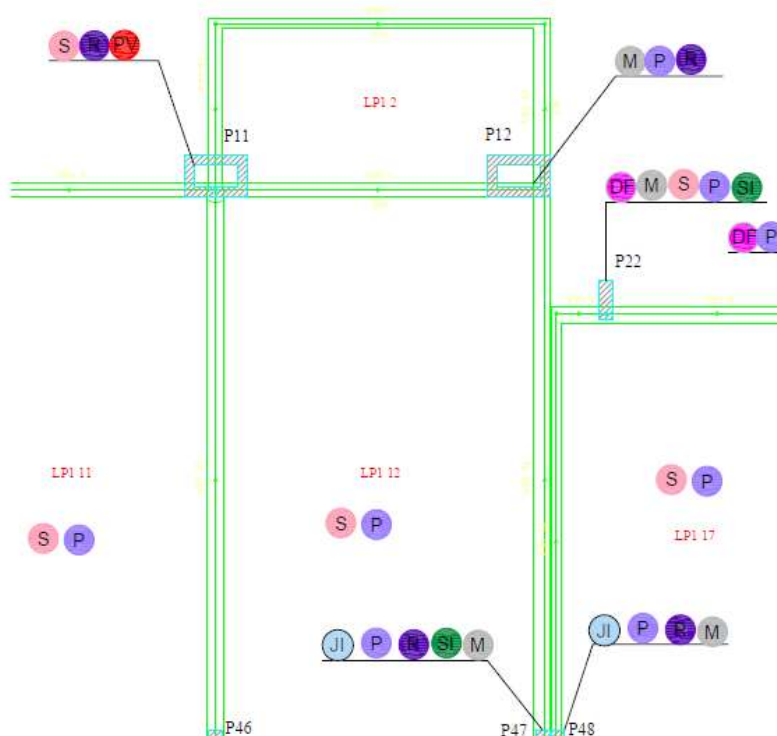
Recorte do mapa de danos do 1º pavimento, vista superior
